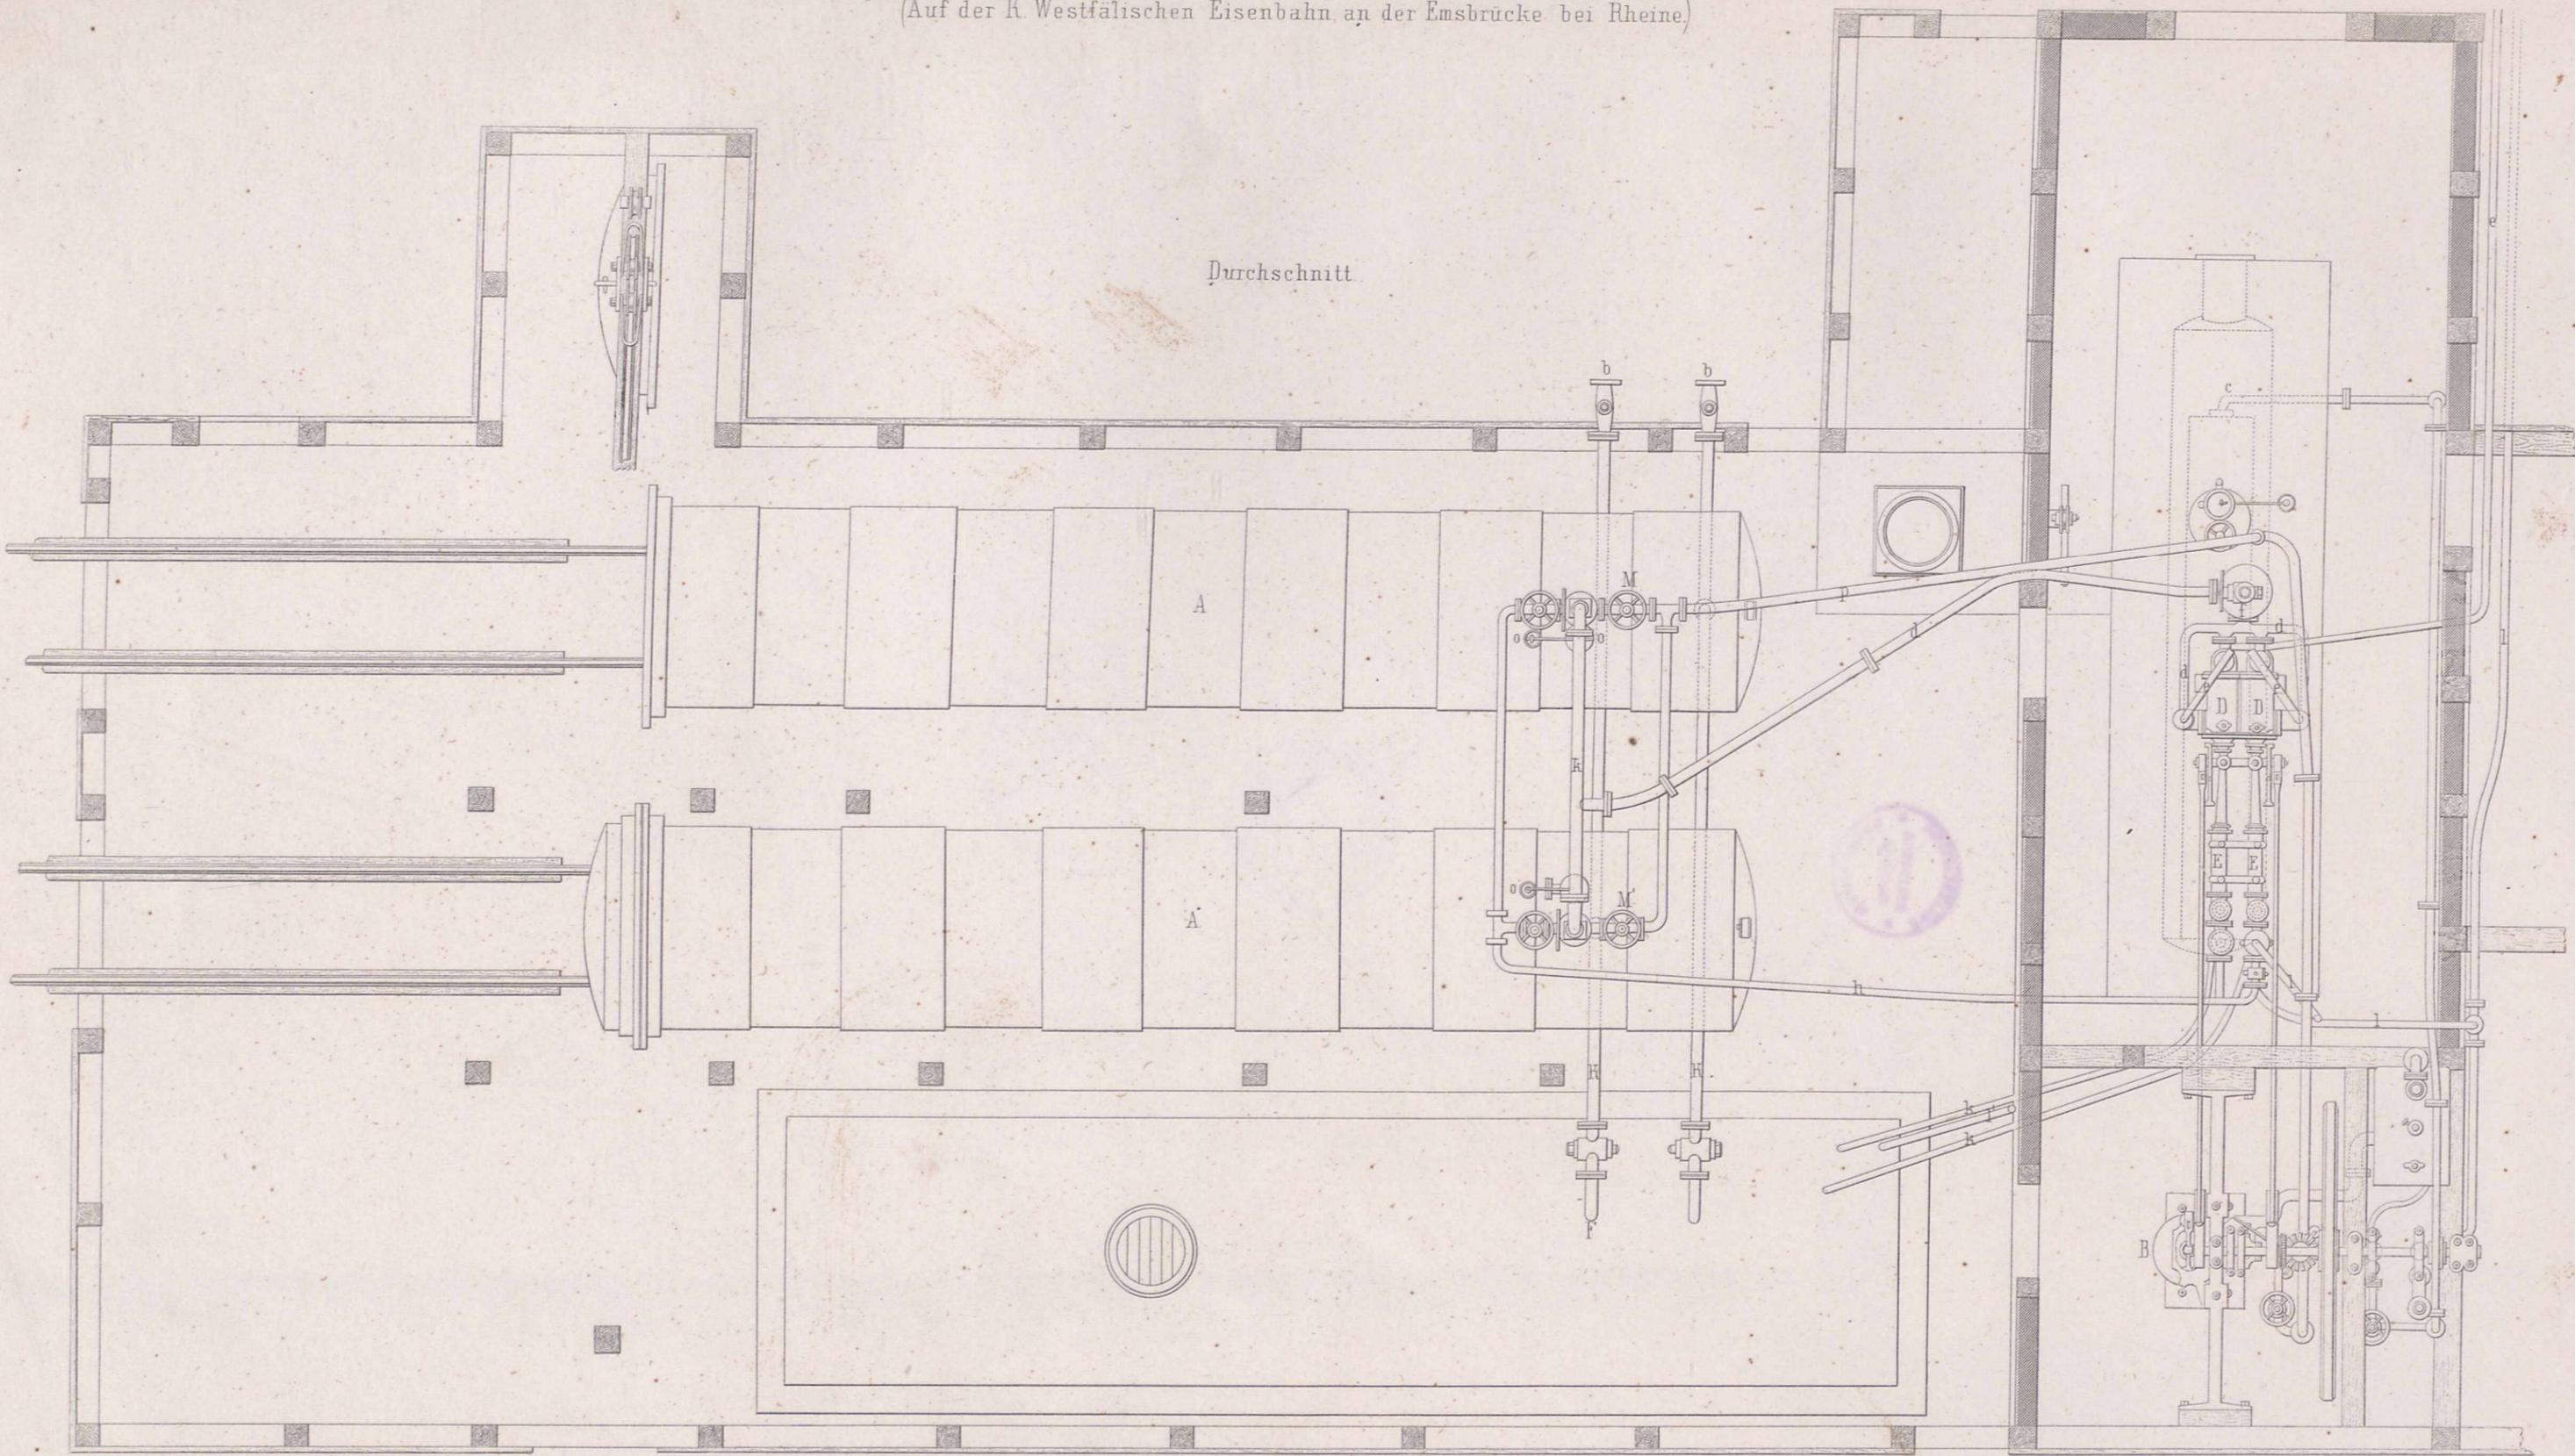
Grundriss u. Horizontaldurchschnitt
